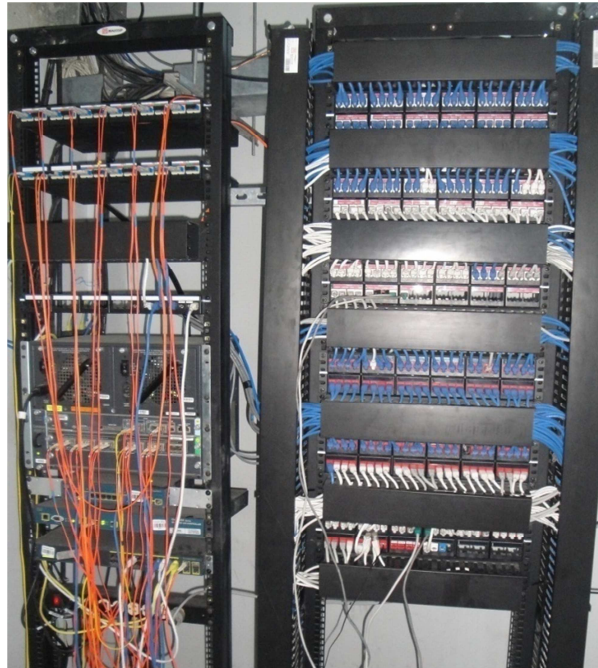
Racks de la planta baja. Nodo principal (1).
